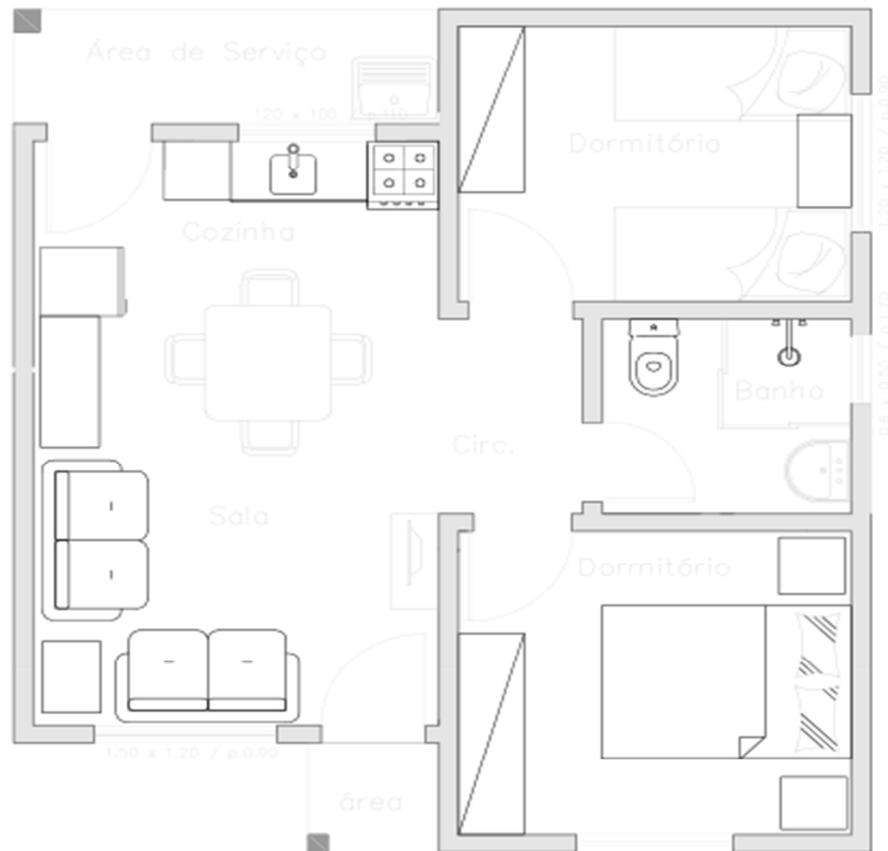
Planta baixa residência em estudo - Levantamento in loco.
